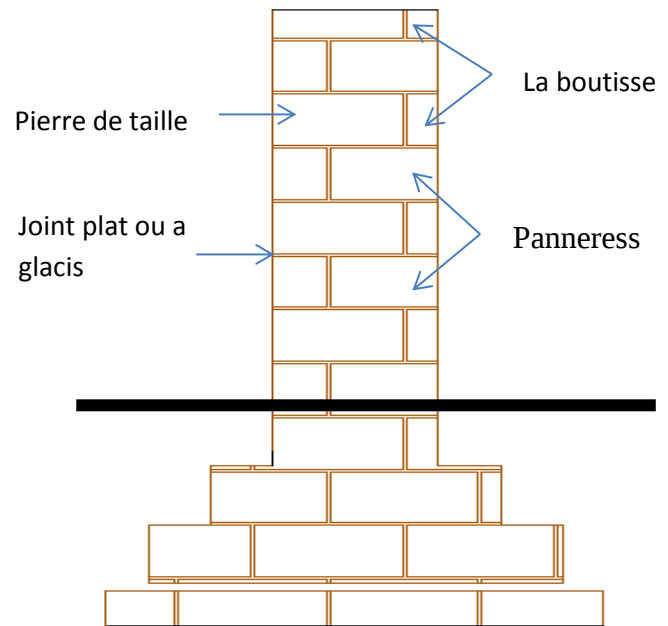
fondation en pierre /Source : l'auteur/
